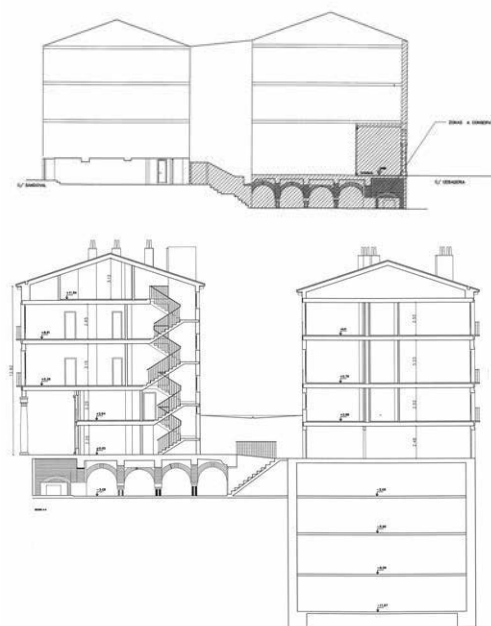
/ Edificio situado en la calle Cebadería 3, antes de su demolición y el nuevo edificio proyectado.
